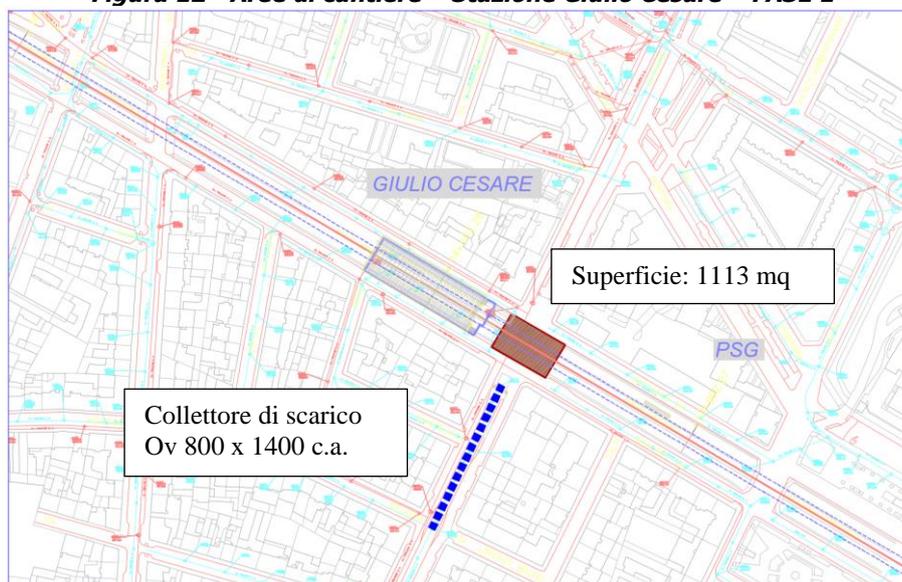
Aree di cantiere – Stazione Giulio Cesare – FASE 1
